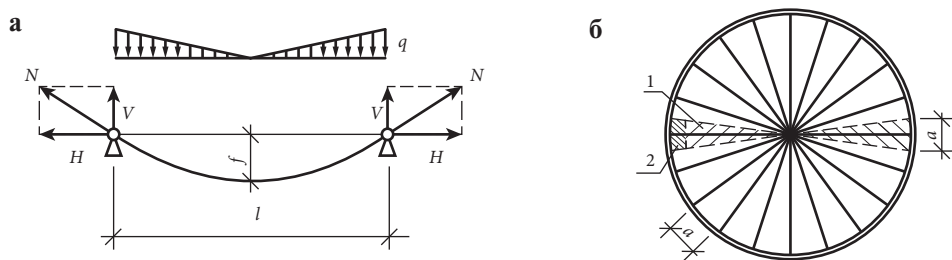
Однопоясное висячее покрытие: а) расчетная схема вант; б) план покрытия; 1 — грузовая площадь ванты; 2 — площадка действия линейной нагрузки
